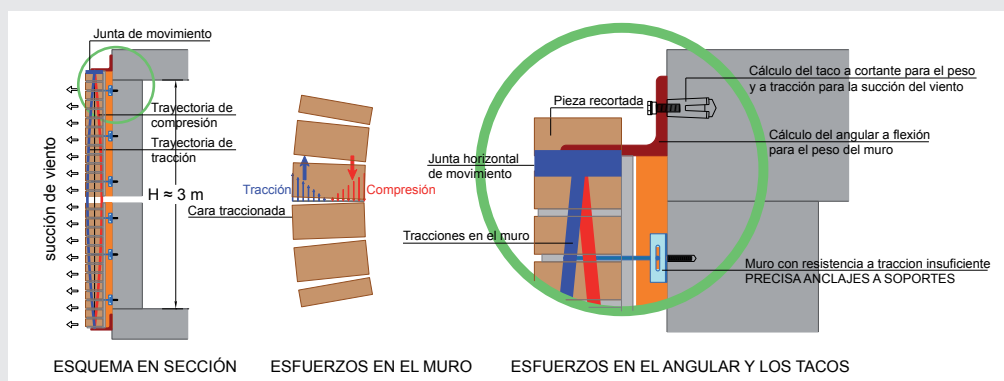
Fachada con junta horizontal de movimiento (*sistema alternativo a la fachada confinada*)
